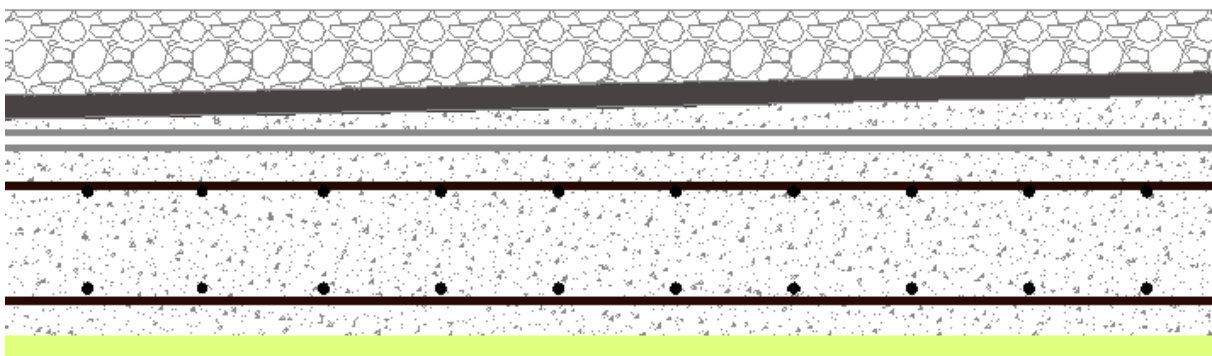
Composants d'un plancher terrasse en dalle pleine.
